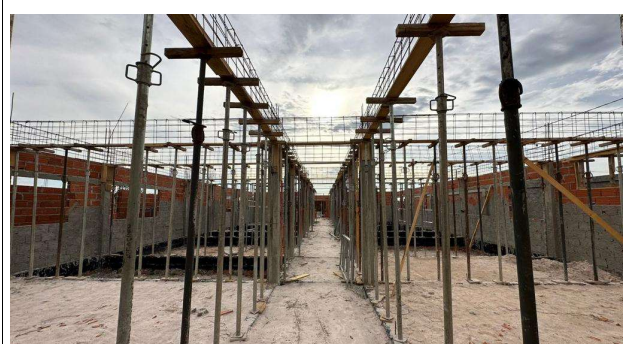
(2.0 Infraestrutura) – Armação de Vigamento
